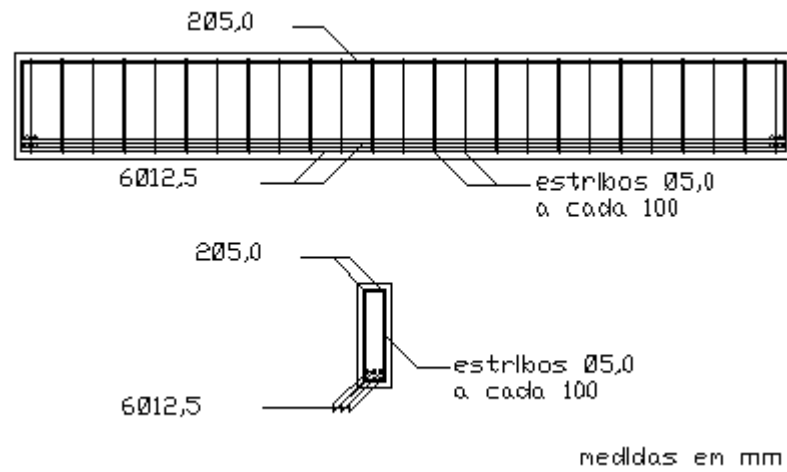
Detalhe da armadura das vigas VM3 e VPF3
